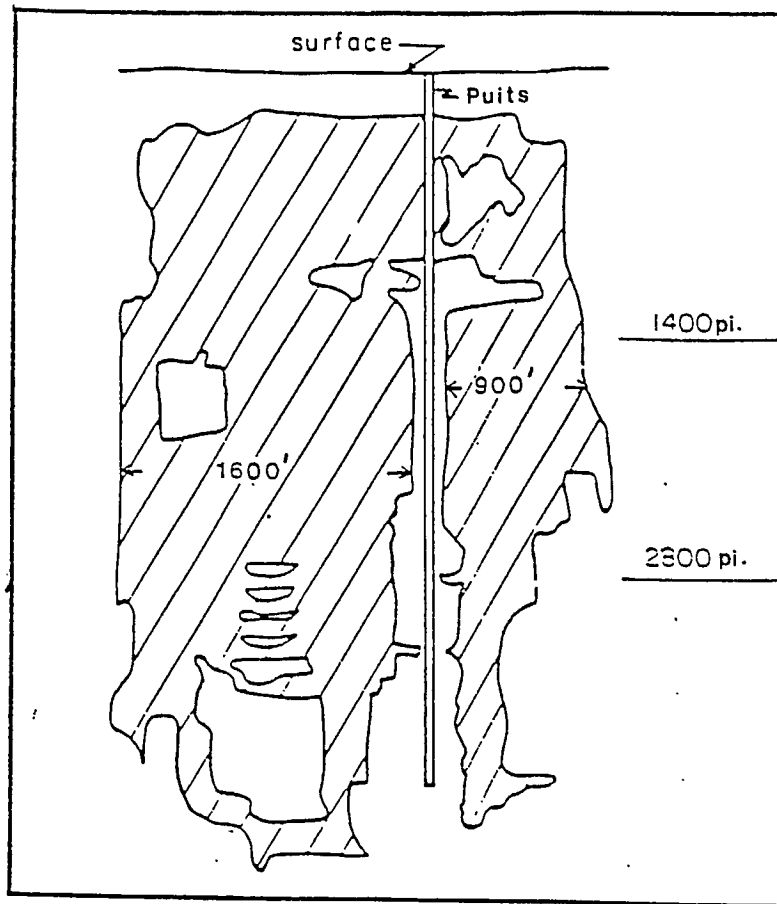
Plan d'une mine au moment d'un coup de toit majeur dans un pilier de puits.
